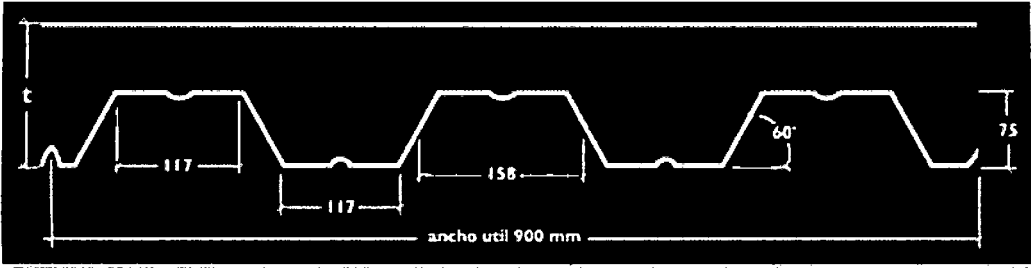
2: Detalle del perfil AD-730 (Acero Deck, 2013).
